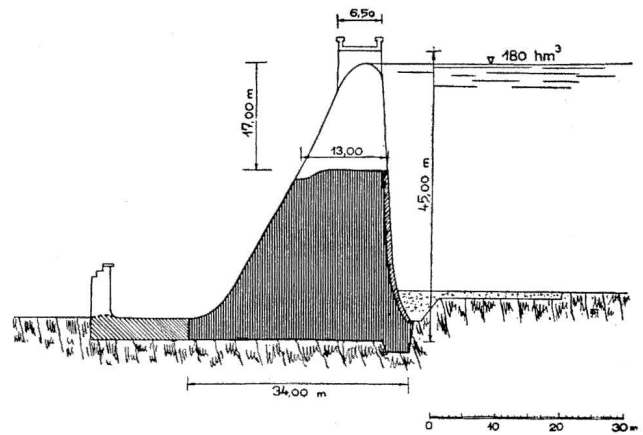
Querschnitt der Eder-Staumauer mit Einzeichnung der Bresche.
